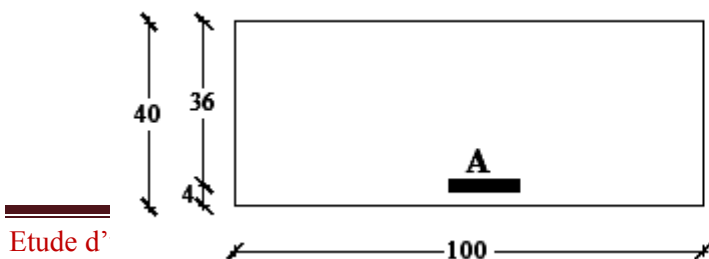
Schéma statique et section de calcul du débordement.
